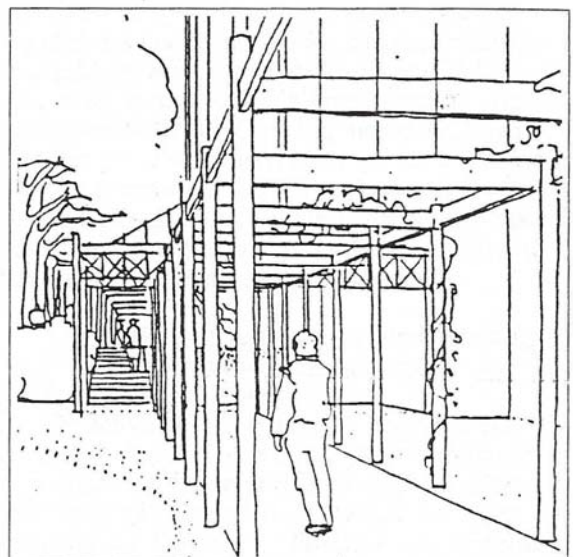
e 7 : Märkisches Viertel, proposta del gruppo di lavoro Hauser/Ostreich-Weinkamm/Team-Grun - Plan, di Wohnumfeldbesserung del lato nord del "I anger .lammer (1)
